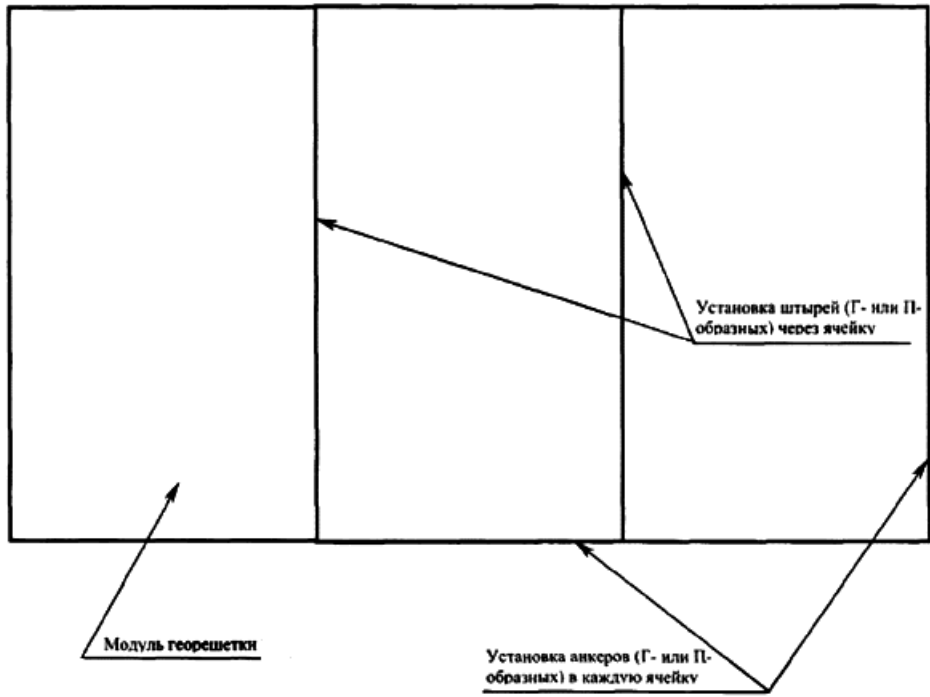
Схема крепления георешетки к земляному полотну анкерами
